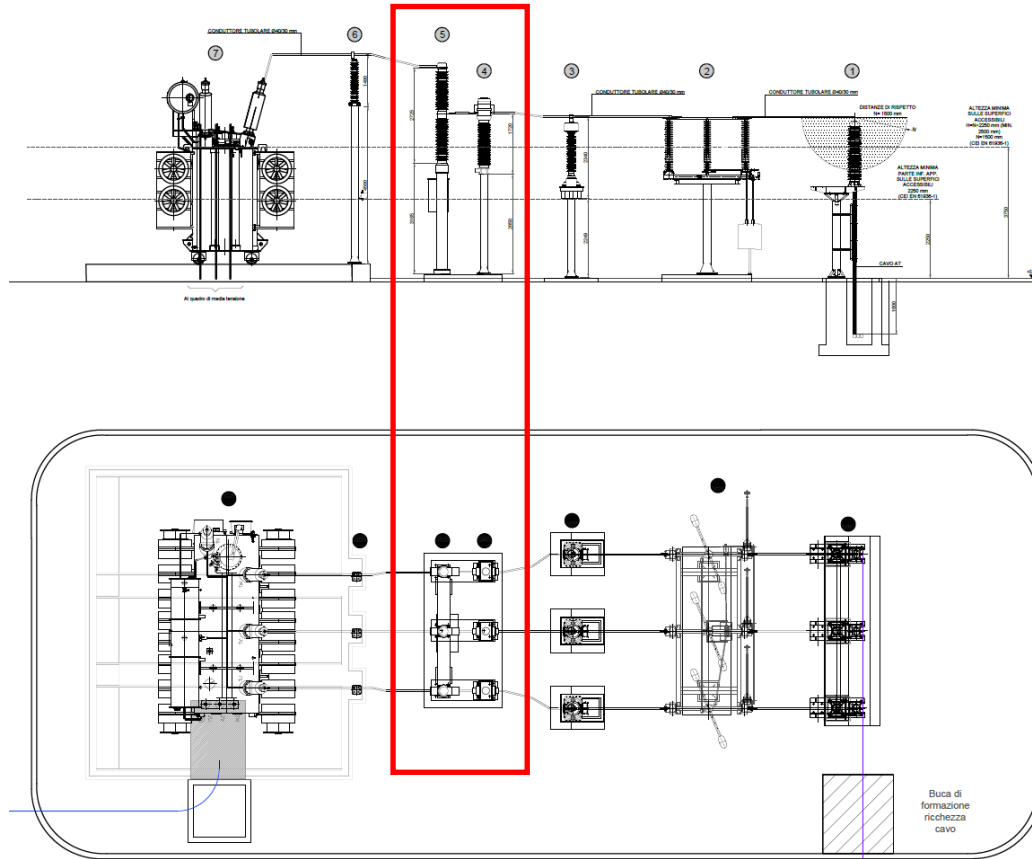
Prospetto e planimetria degli elementi della sottostazione utente.
